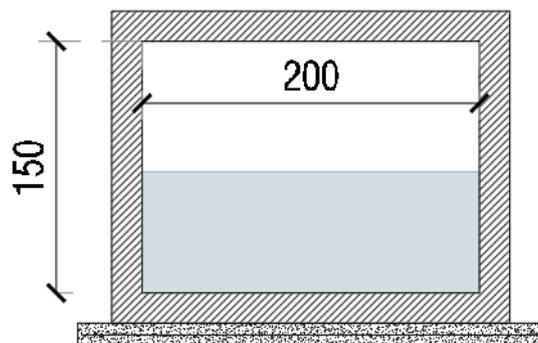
Sezione tipologica scatolare attraversamento 2000x1500
